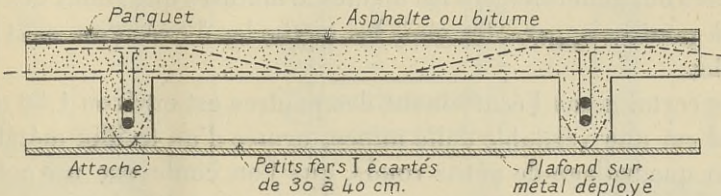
Nervures espacées de 4 mètre 50 ou plus et dalle en béton armé.
